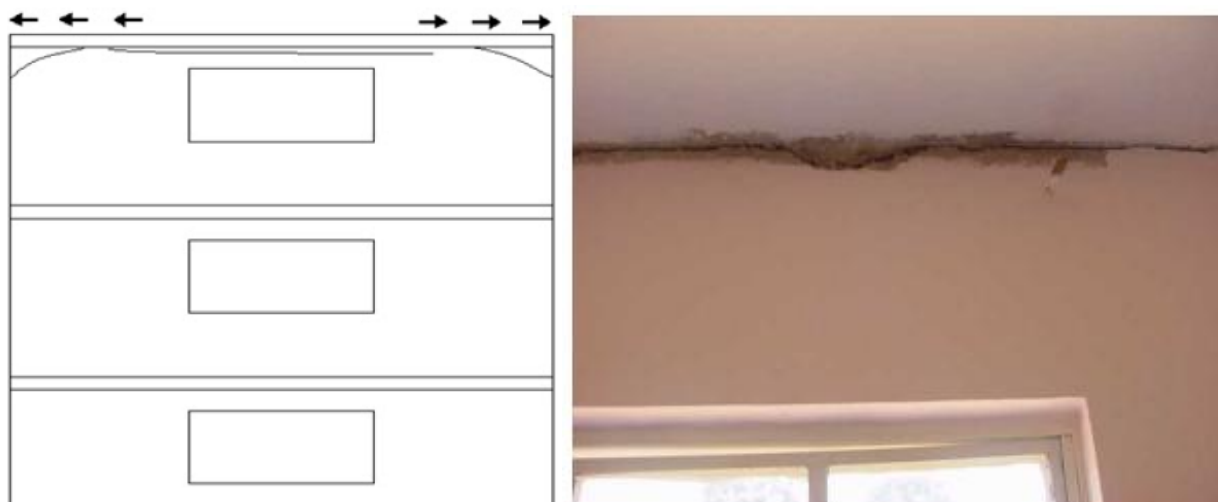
Fissura horizontal causada pela movimentação da laje de cobertura
